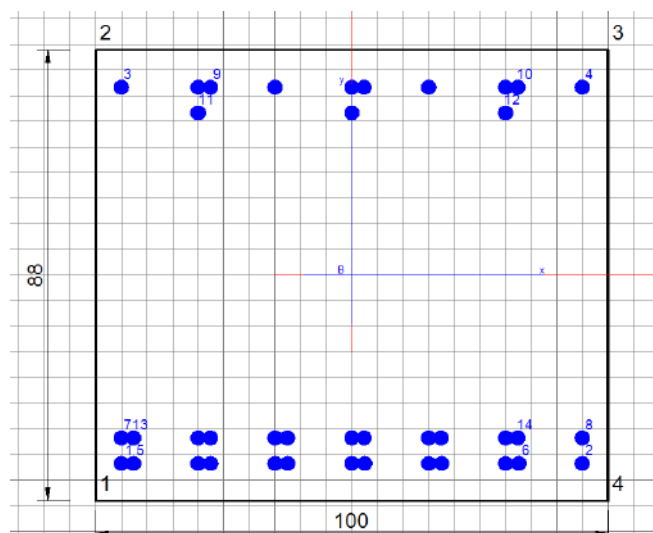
direzione orizzontale- Zona 1B - Sezione 1000x880
